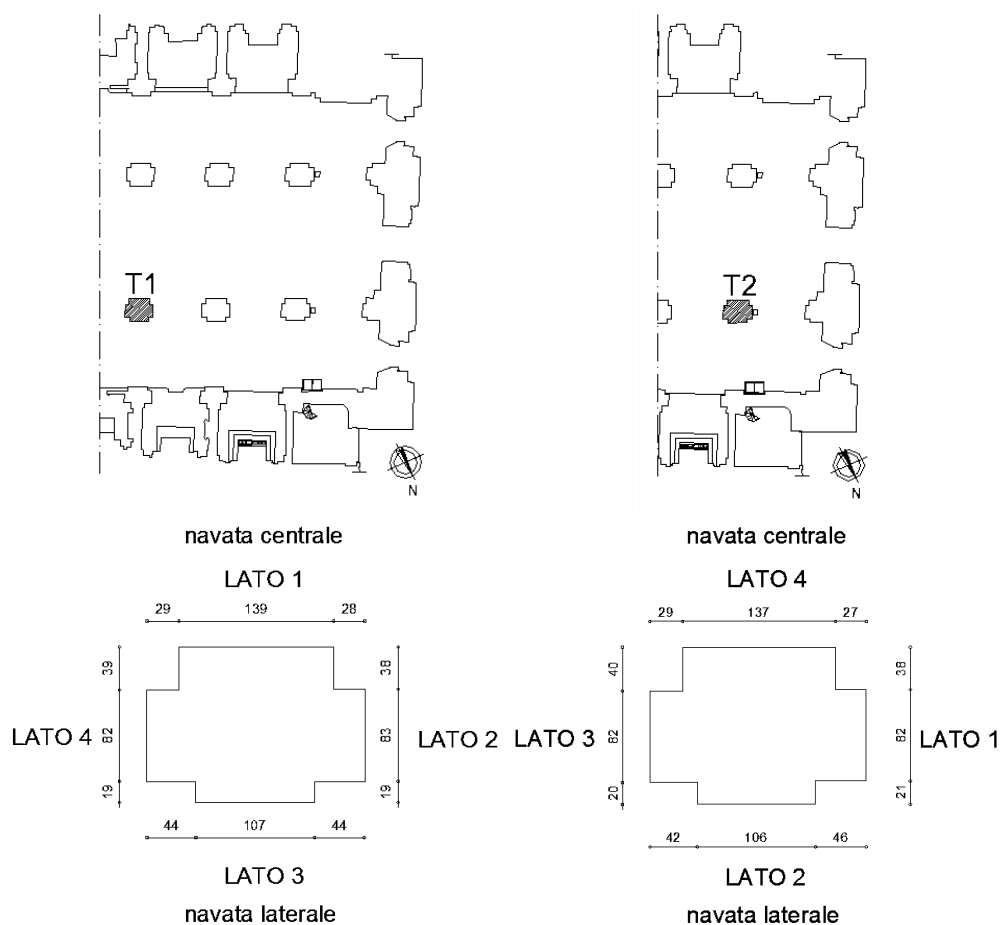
Collocazione in pianta dei pilastri sottoposti ad indagine tomografica (sopra) e loro rilievo geometrico (sotto) (Semenzato, 2005).
